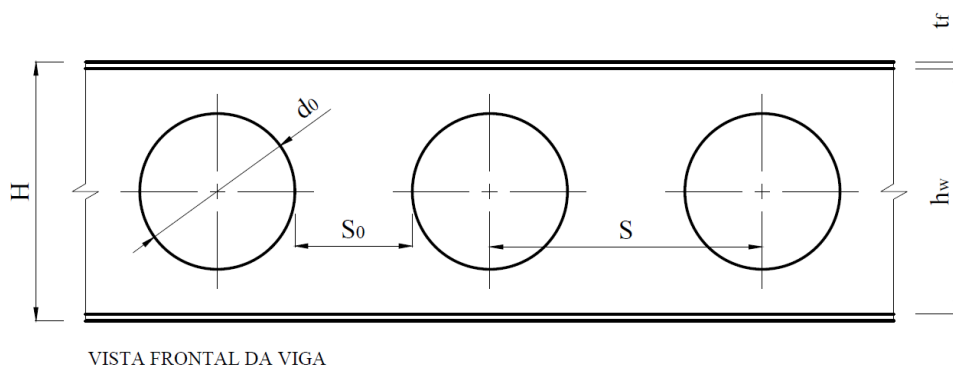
Dimensões geométricas da viga alveolar - vista frontal.
